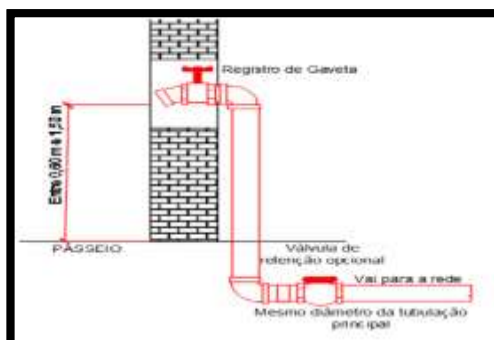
Hidrante Recalque na fachada ou muro de divisa
